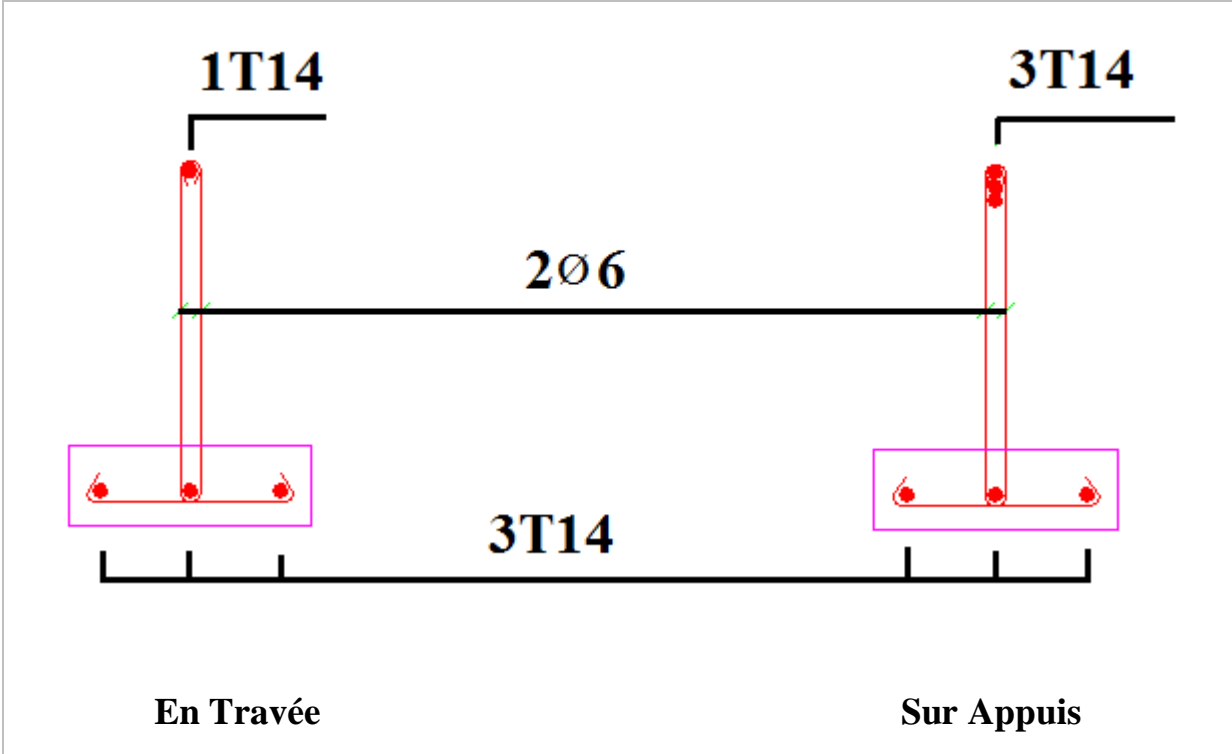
Ferrailage des poutrelles en travées et sur appuis.
